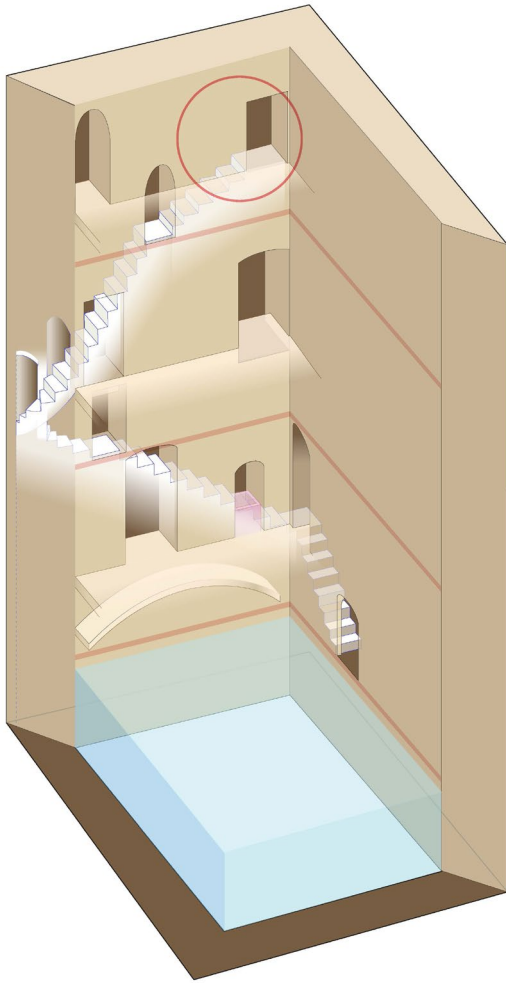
Reconstrucción esquemática de la escalera (M. Salvatierra)
